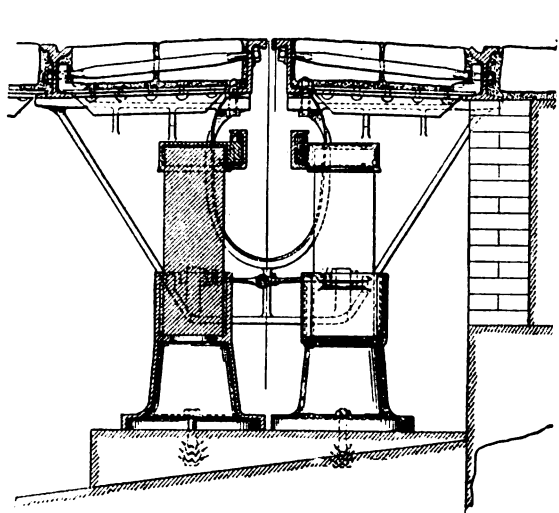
Coupe du caniveau. Conducteurs fixés sur piliers.
